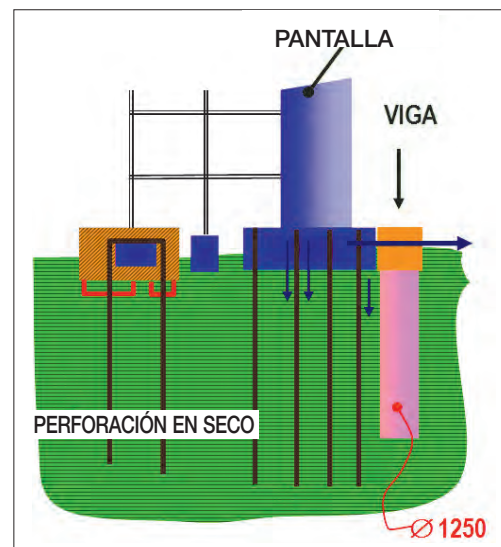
RECALCE DEL EDIFICIO EN BENIDORM: ALZADO (gentileza de Terratest).
